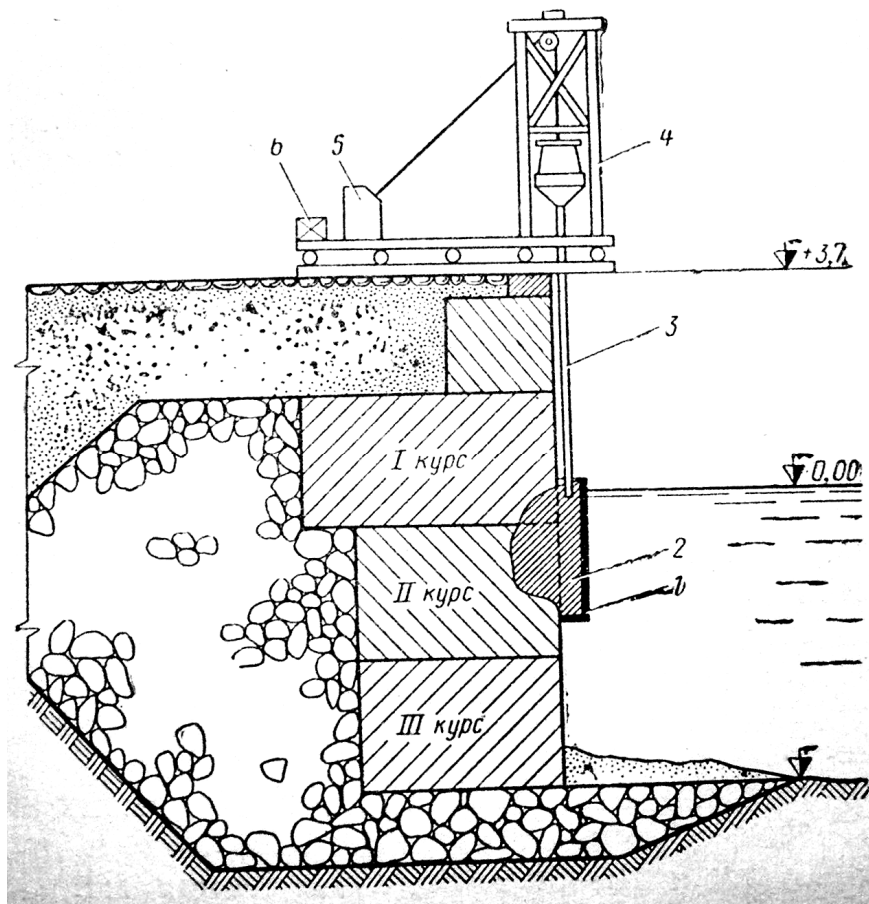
Бетонування залізобетонного поясу методом ВПТ [13]:
